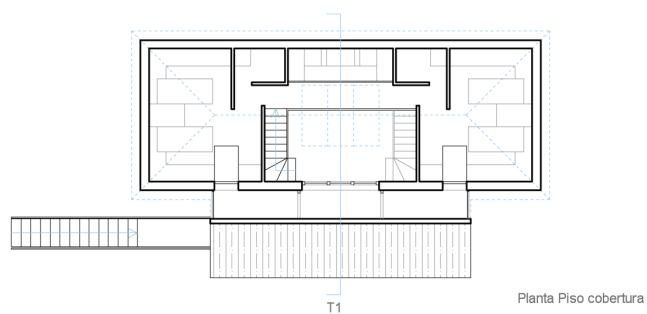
Casa Arturo Estevez: Planta de coberturas
